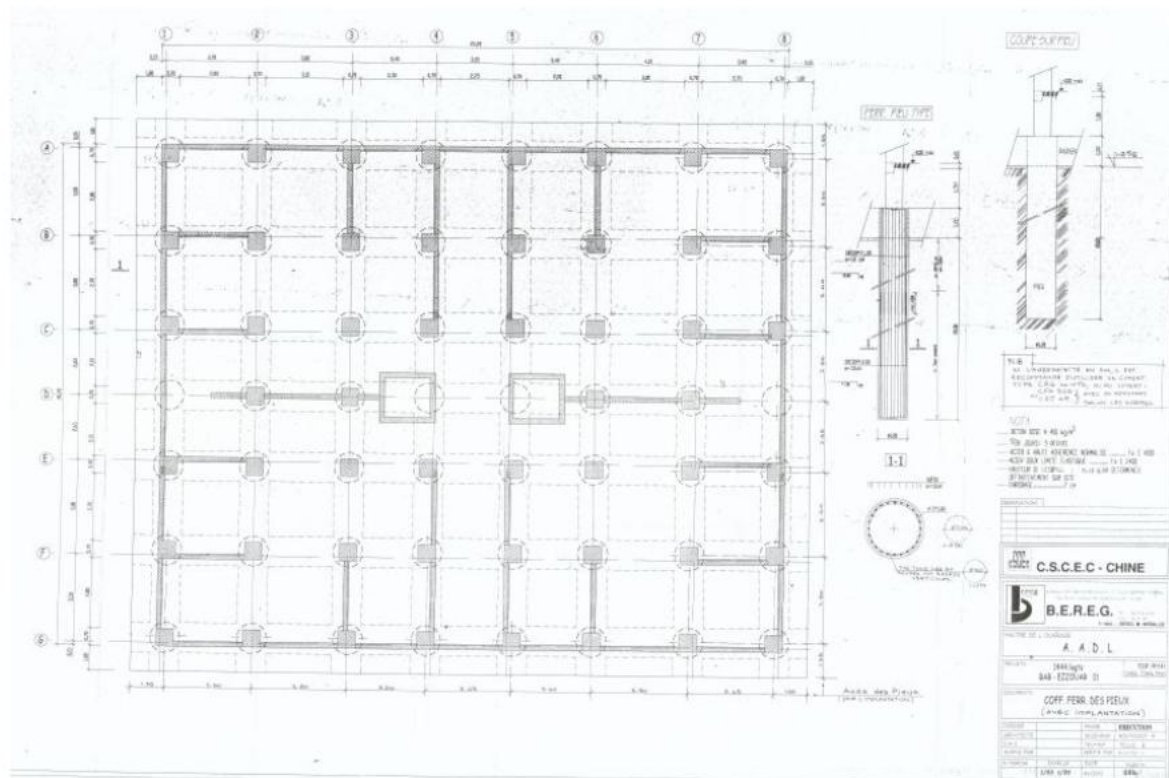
Plan des fondations par pieux des immeubles résidentiels 1 à 4 près de la station Smail Yefsah
